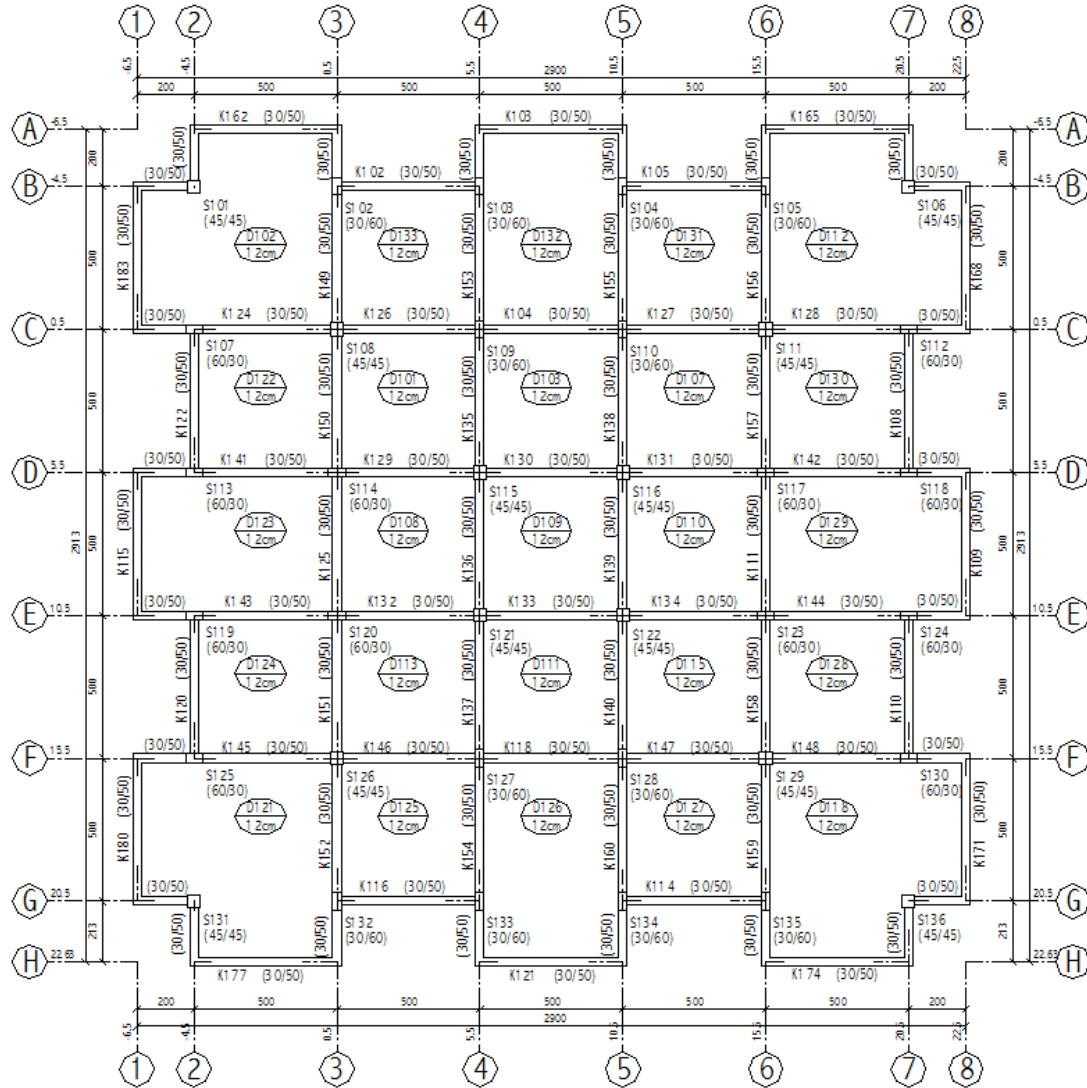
Bina B 5 katlı kirişli plan bilgisi
